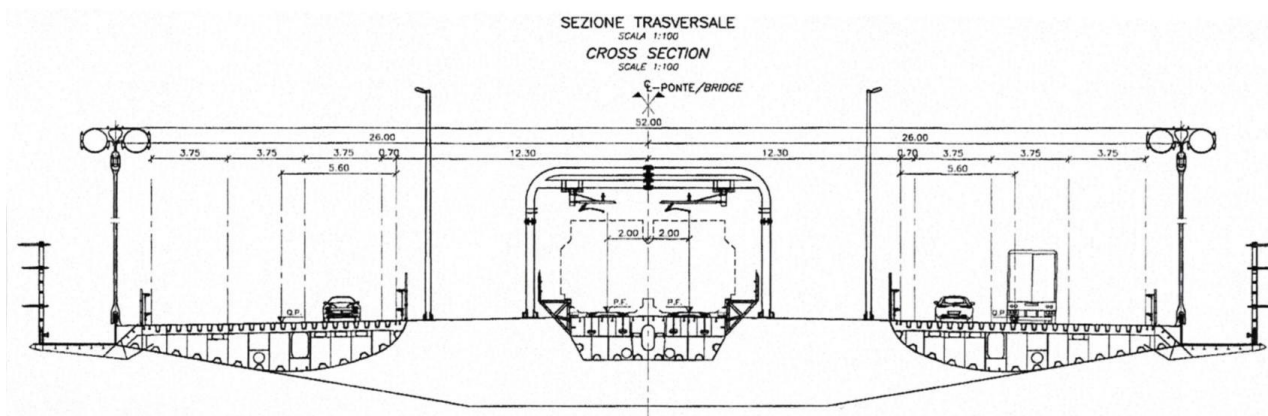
Sezione dell'impalcato, Progetto Definitivo 2011 – Elaborato PG0004
